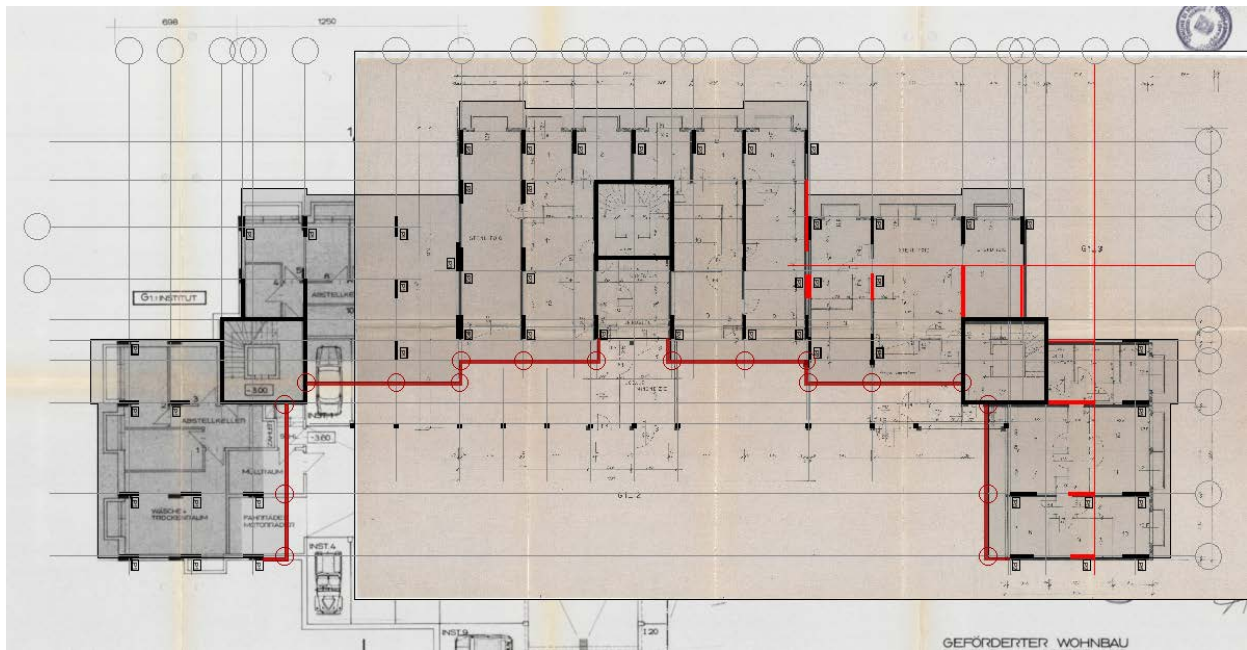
Planimetria dell'attacco a terra dell'edificio sito in Piazza S. Vigilio, Merano (archivio IPES)
